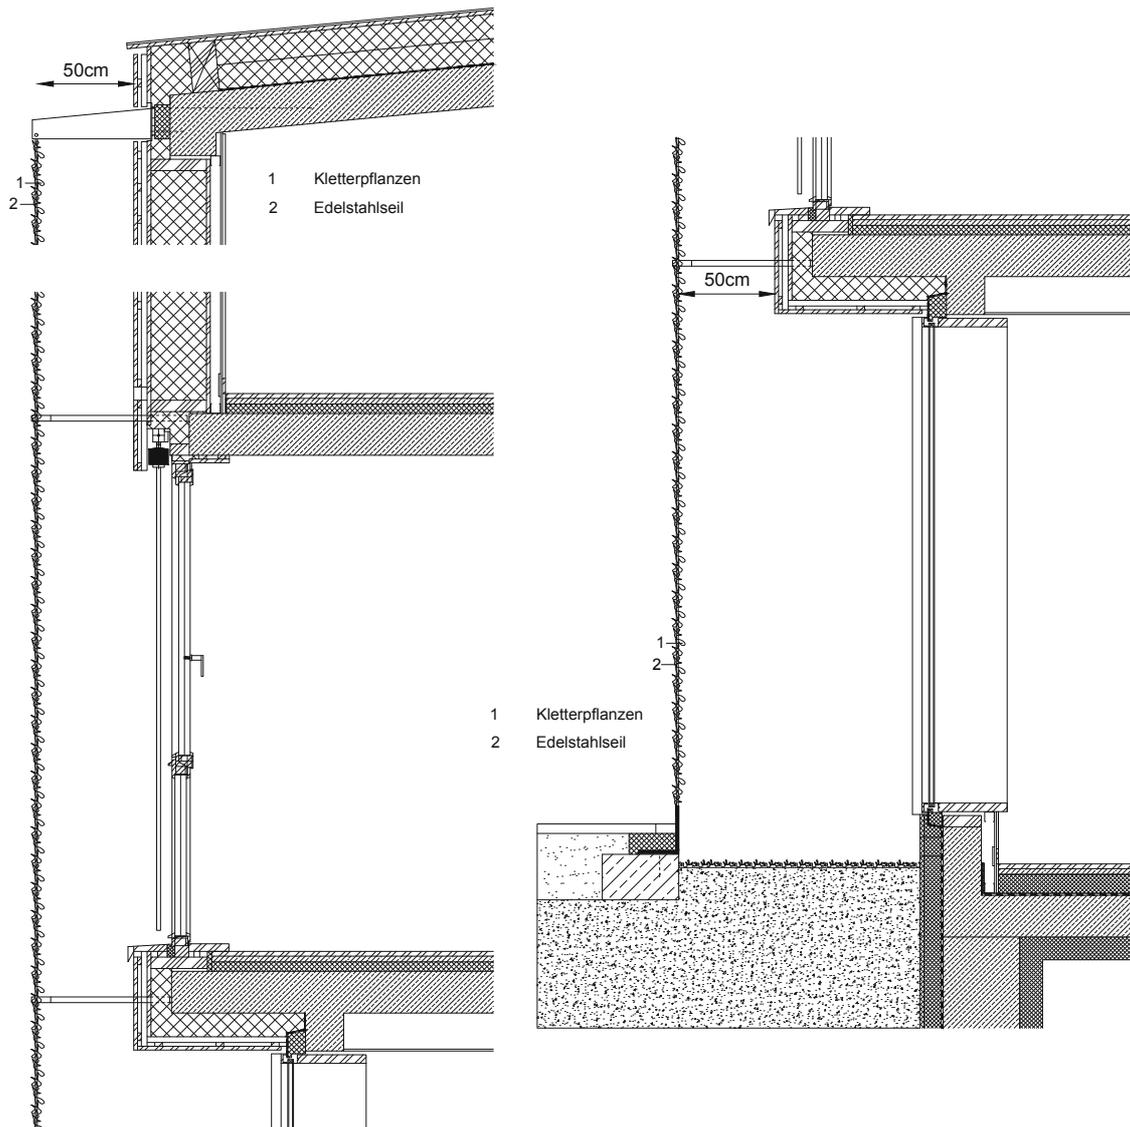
Begrünung Südfassade Stadthaus M1 – Aufbau, eigene Darstellung © Barkow Leibinger [33]
